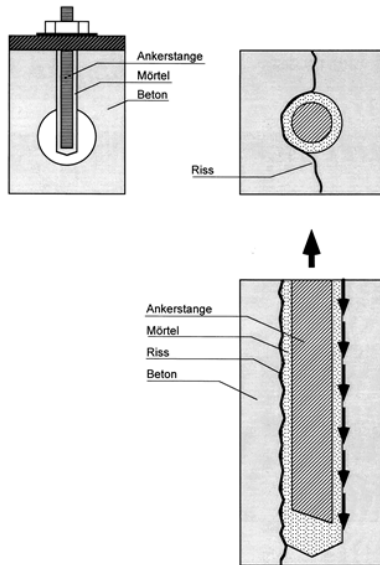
Störung des Verbundes zwischen Mörtel und Beton durch einen Riss im Ankergrund (Eligehausen/Mallée (2000))
